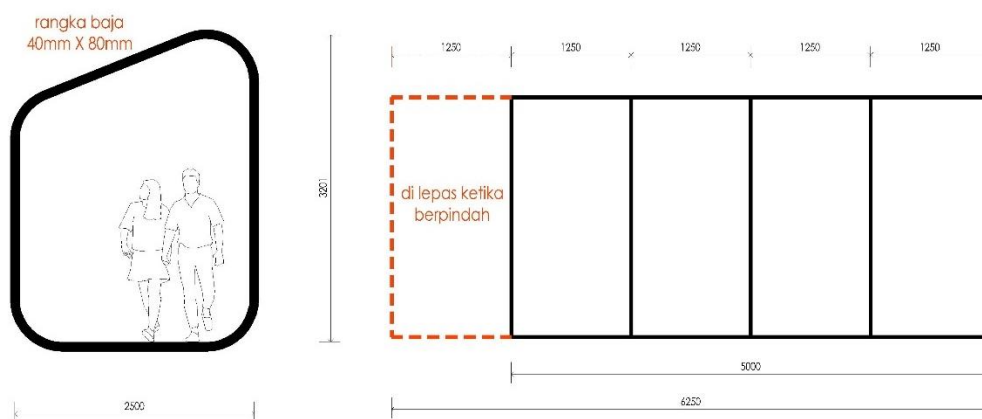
Gambar Konsep Gubahan Susunan Ruang
